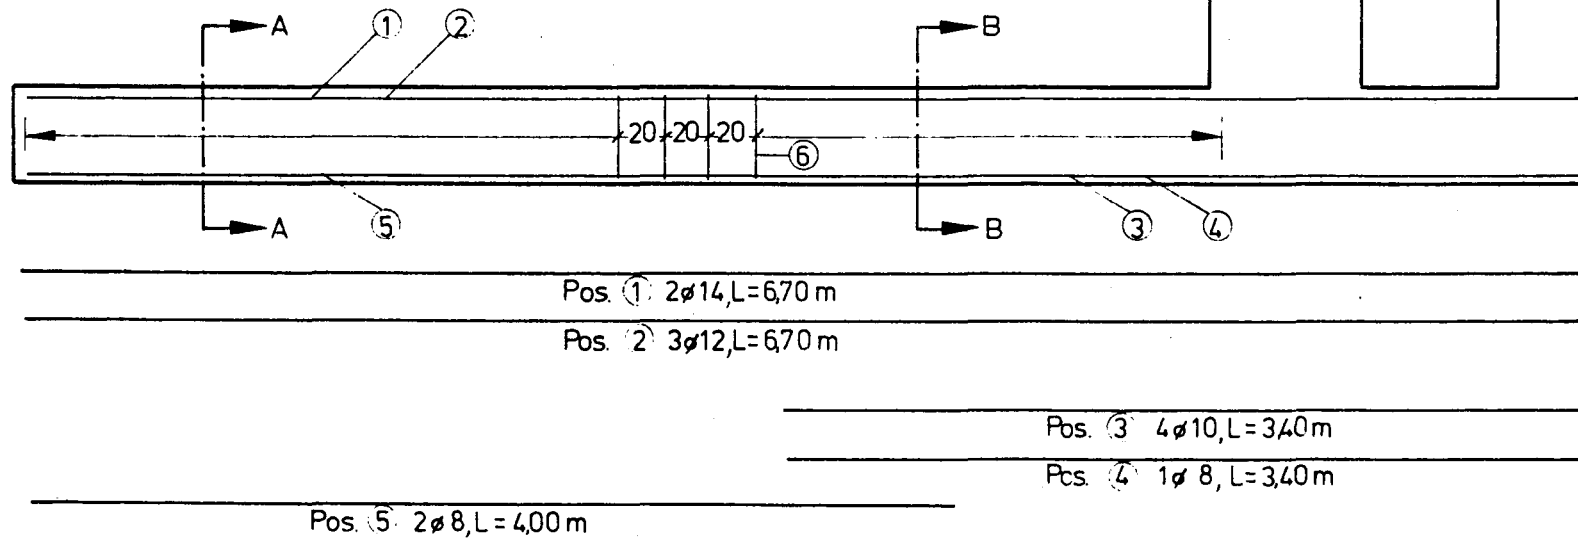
Bewehrungsplan des Versuchsbalkens B I
